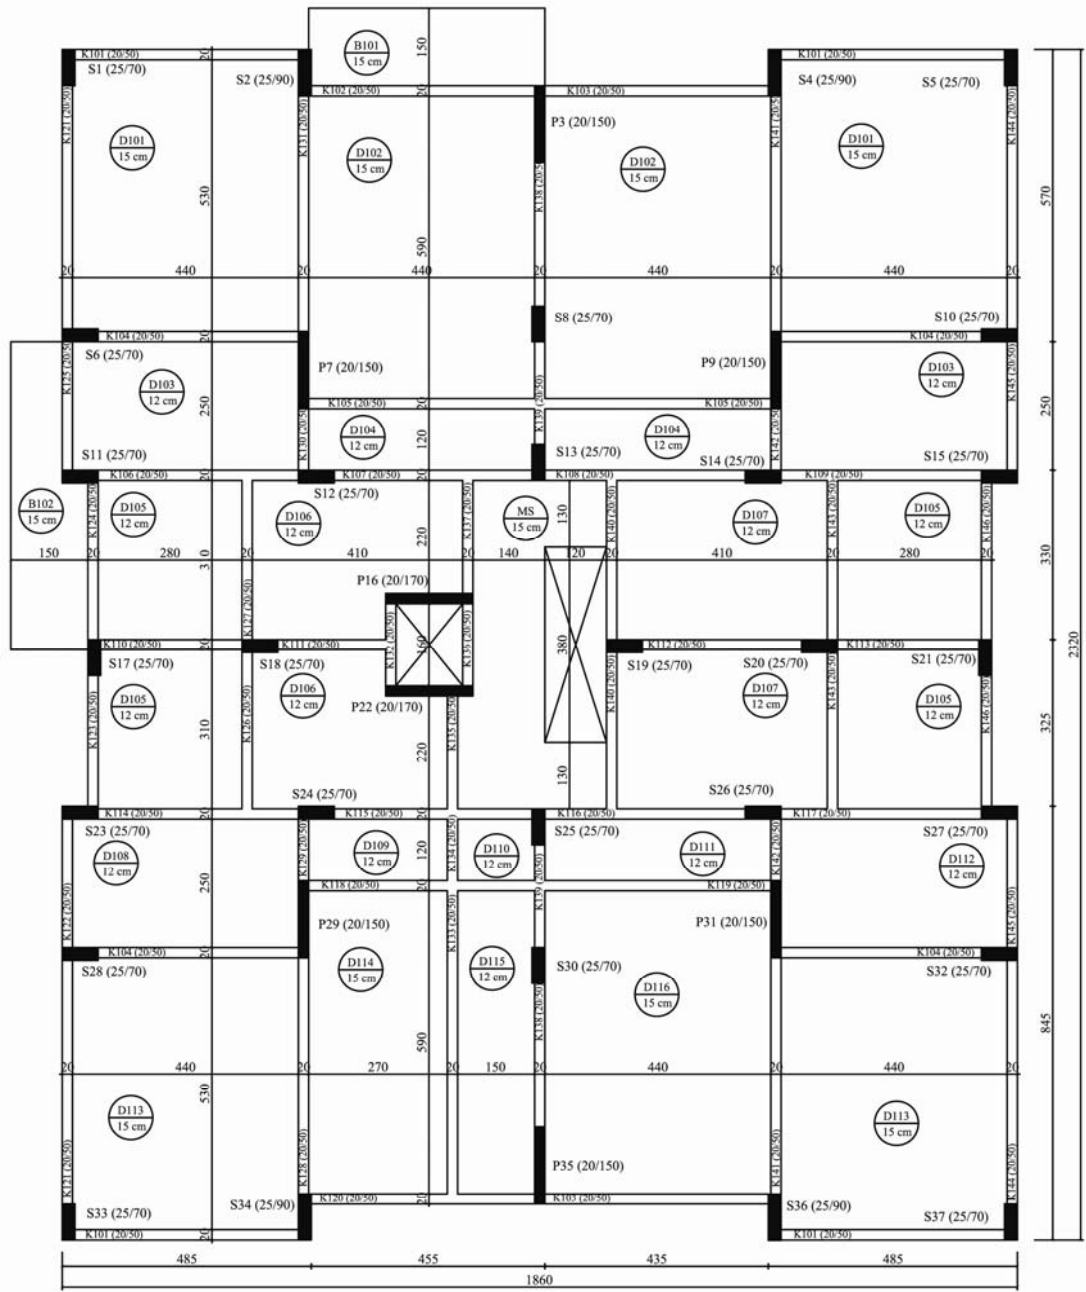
B7\_2'nin kat kalıp planı
